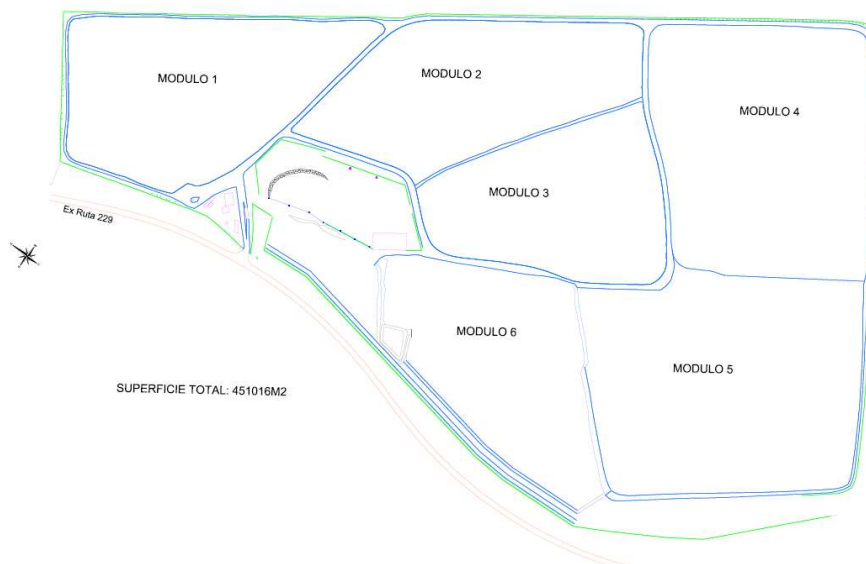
Plano base para observar el sector a sanear, limpiar y construir
